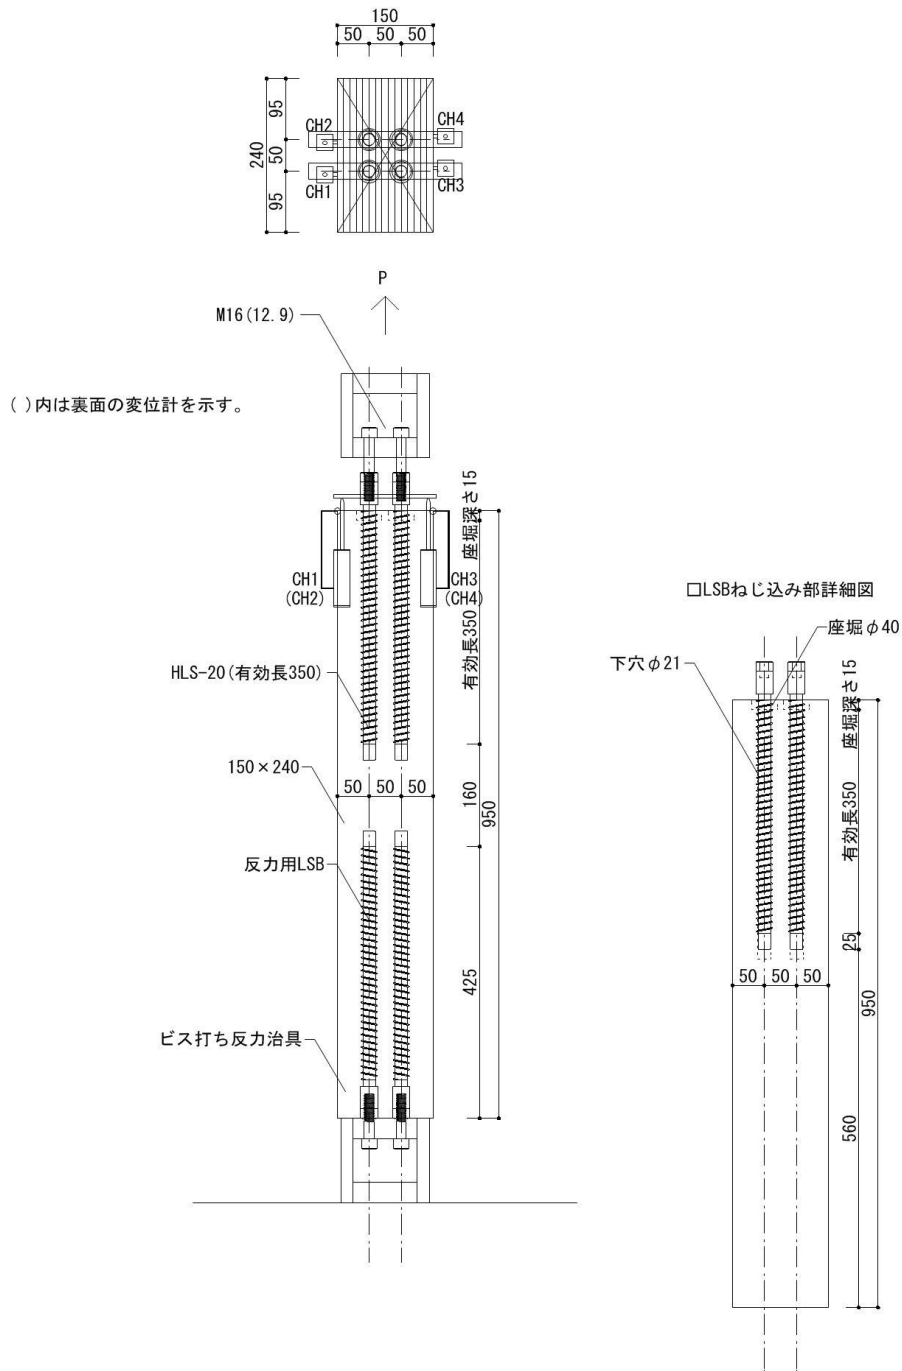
試験体の形状及び寸法 (A-3)
